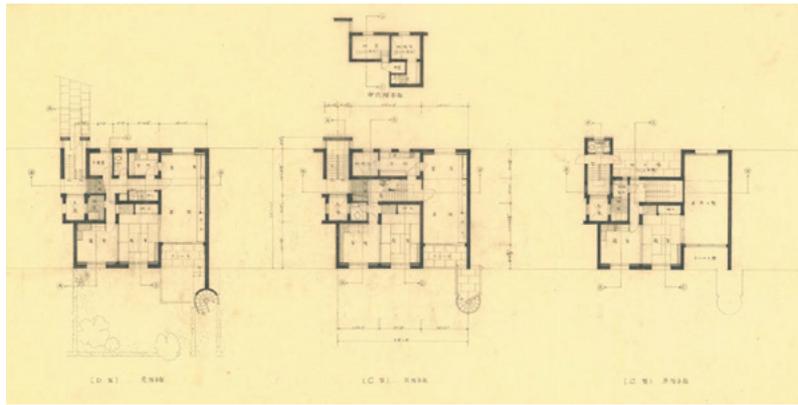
日本人住宅 C,D 型平面图 第五案 [1052]
